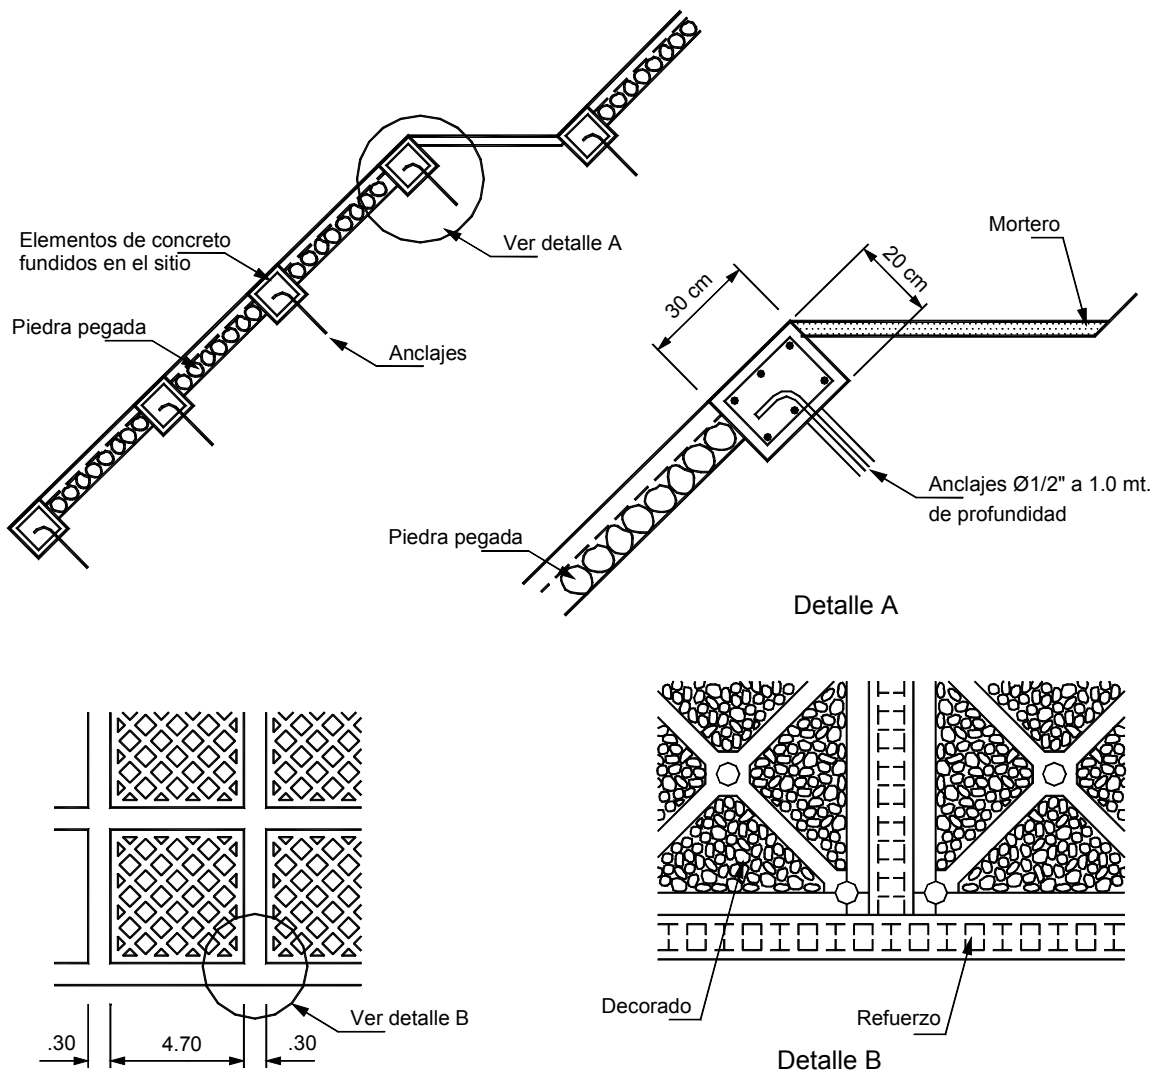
Protección con elementos de hormigón armado decorados.
